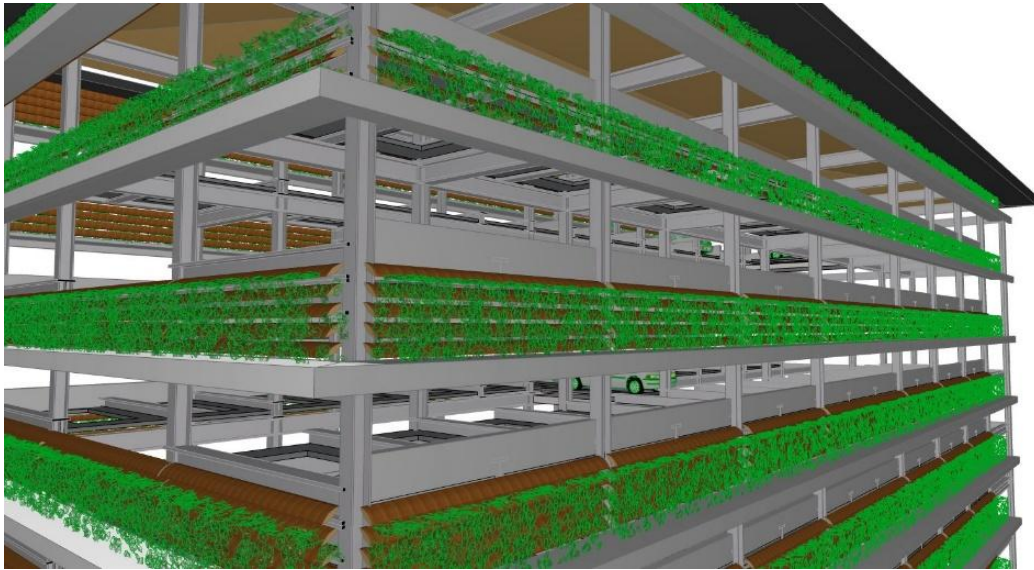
layout gedung parkir sagan (sumber: analisa penulis)
